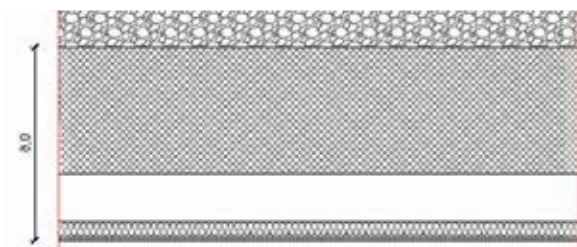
Abaco - C.V. 03 - Muro controterra in cemento armato
